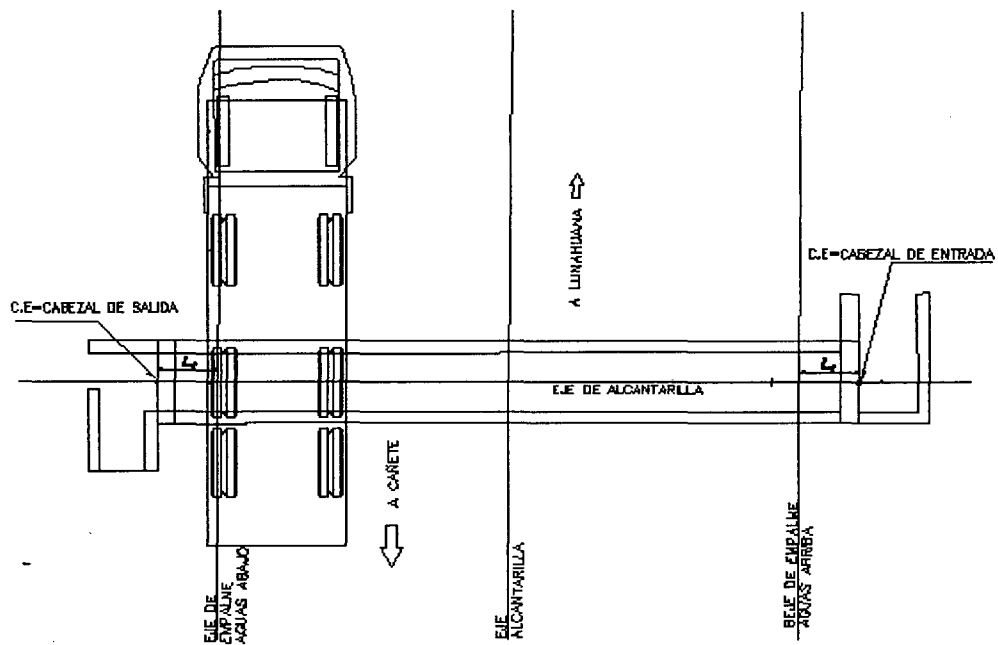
Ubicación del camión en planta para la prueba de junta con carga en borde lateral
